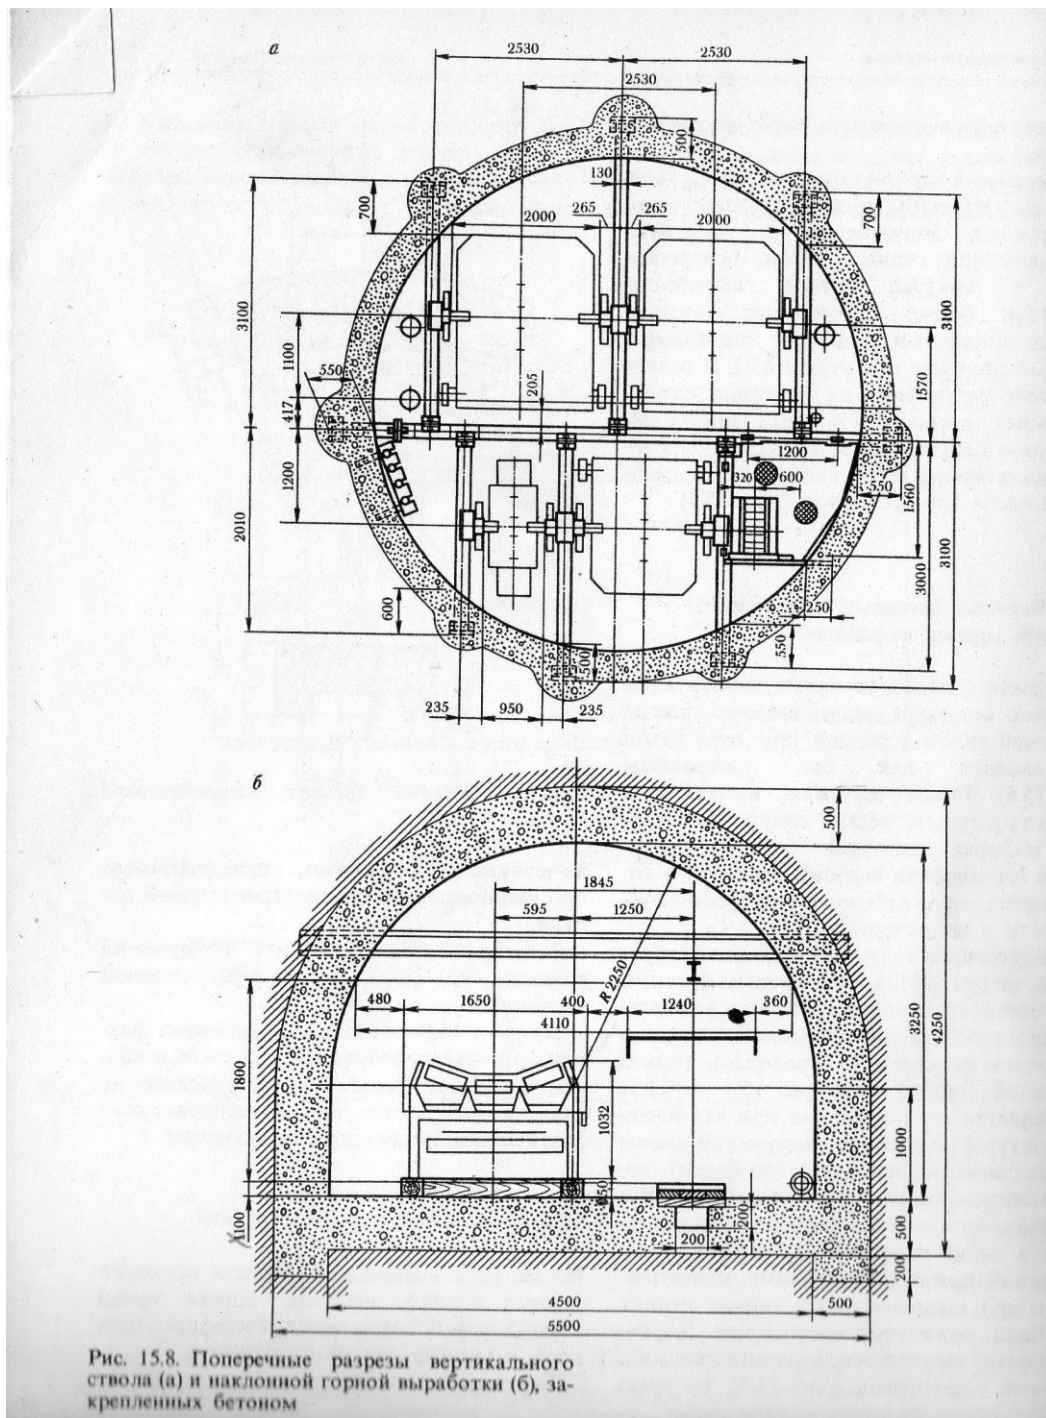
Поперечные разрезы вертикального ствола (а) и наклонной горной выработки (б), закрепленных бетоном
